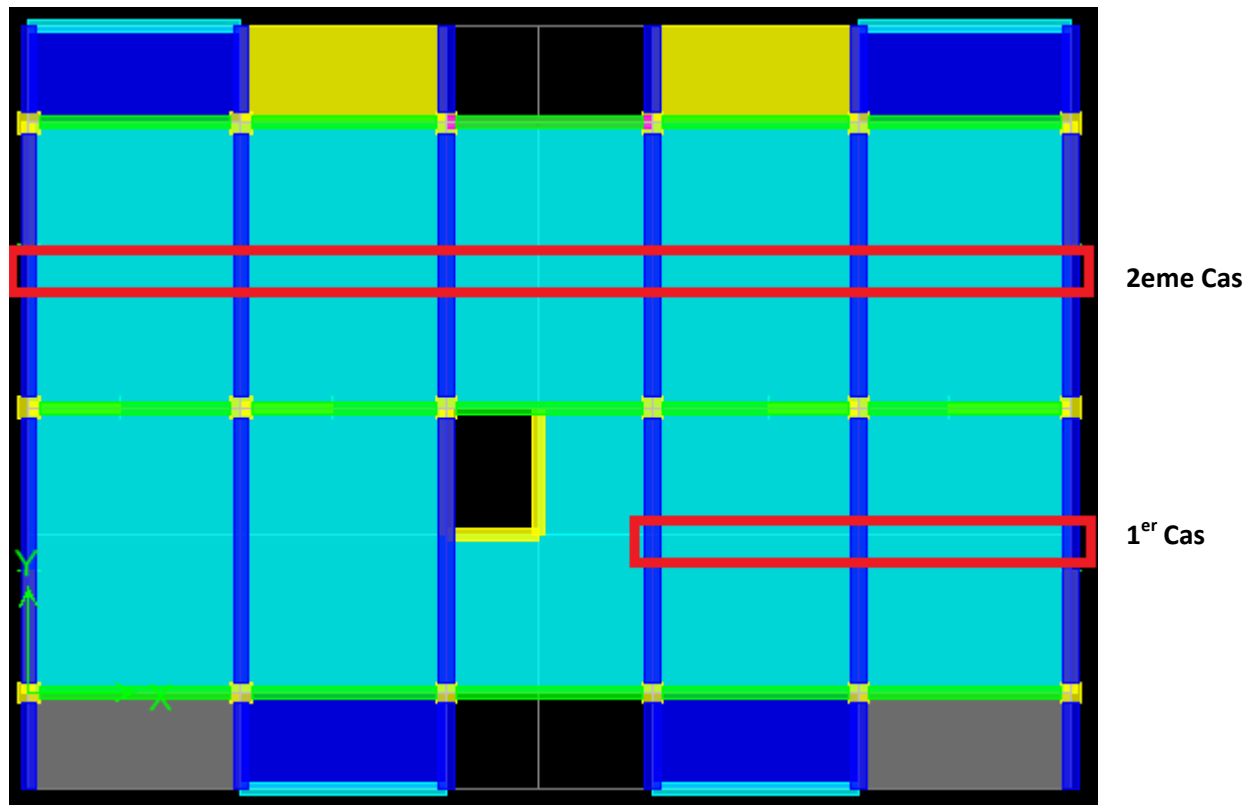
Schémas représentent des 02 types de poutrelles
